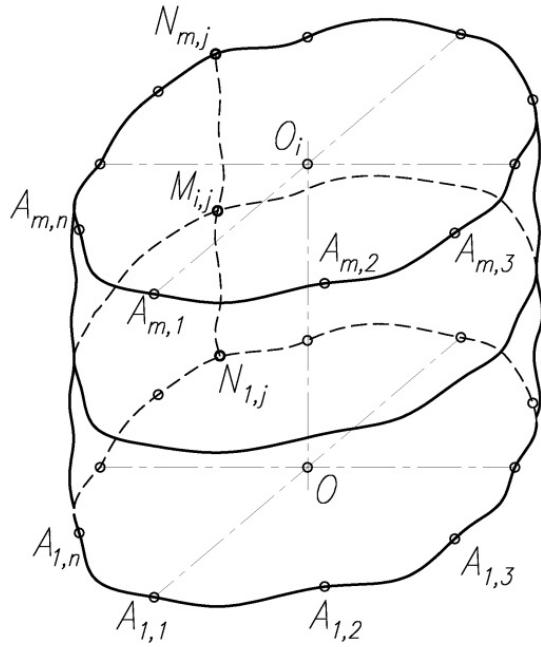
Геометрическая схема поверхности резервуара с несовершенствами
